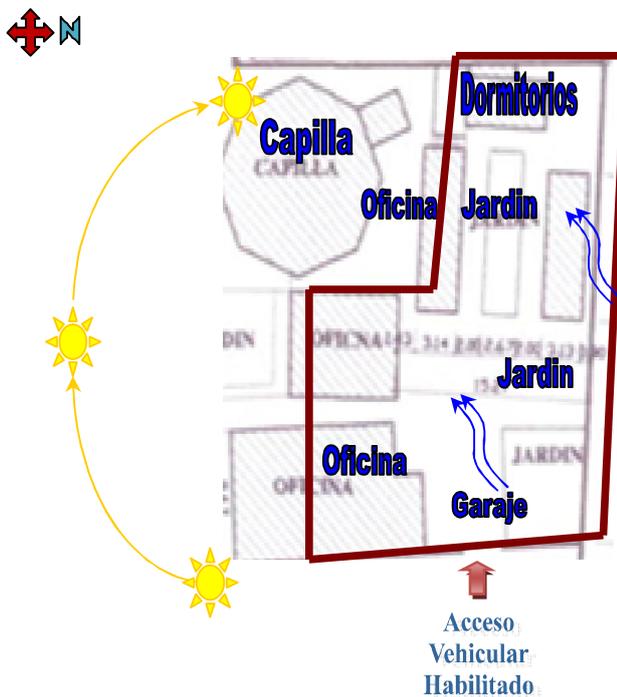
Planta Arquitectónica área Privada de religiosas. / Fuente: Propia
